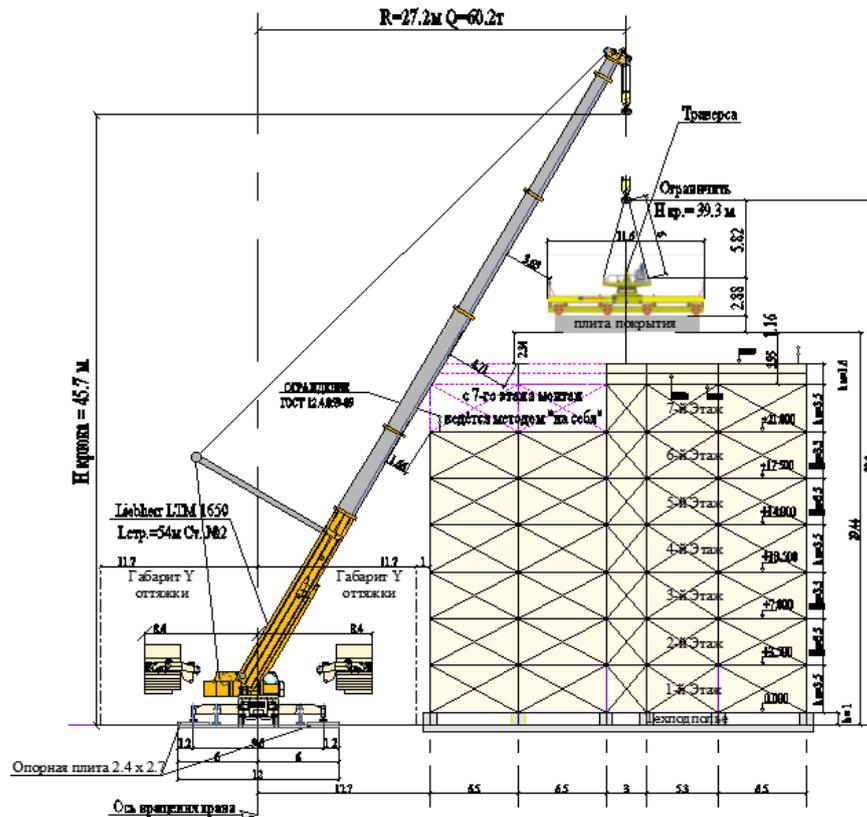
Схема имитационного моделирования механизации монтажных работ мобильным краном на спецшасси для жилого здания «Башня» «Тип 1». Разрез.
